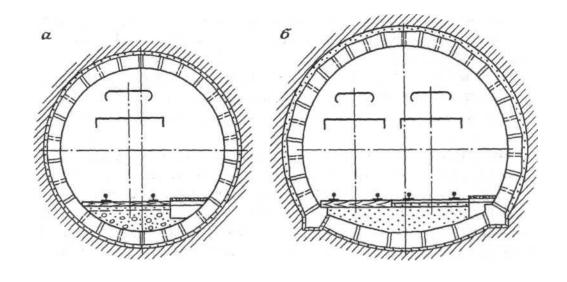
Конструкции бетонных крепей БК конструкции НИИОГРа
